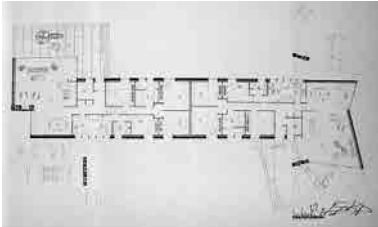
Planta baja tipo de una de las 266 viviendas para militares americanos; José López Zanón, Luis Laorga Gutiérrez y Ernest J. Kump; Zaragoza, 1955-1958.
